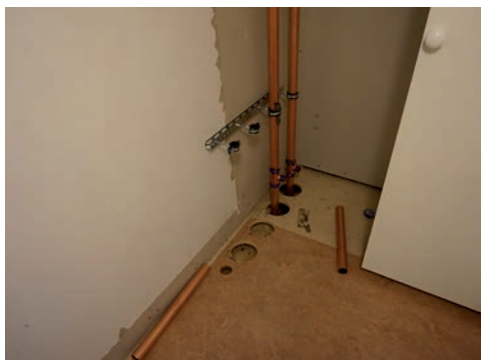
Rördragning mellan våningsplan, senare täckt av garderob. Foto: Tobias Mårud.
